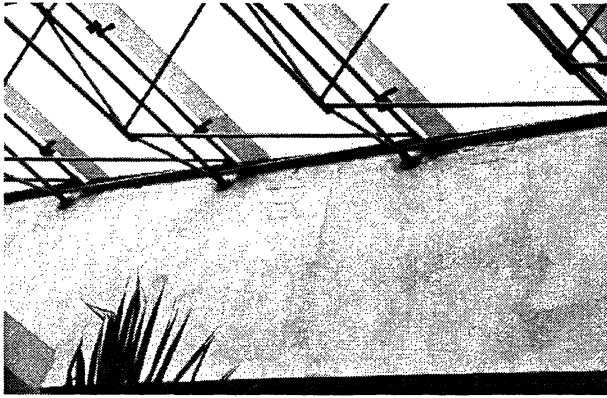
Grietas en la argamasa de regularización, armadura expuesta y desplazamiento del hormigón.
